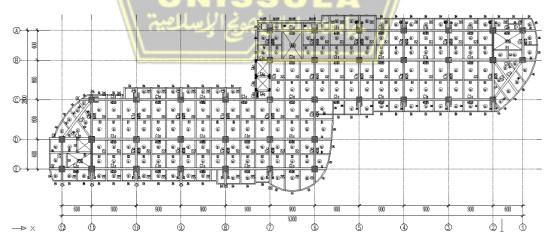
Gambar Denah Pondasi Sumber: DED Proyek
